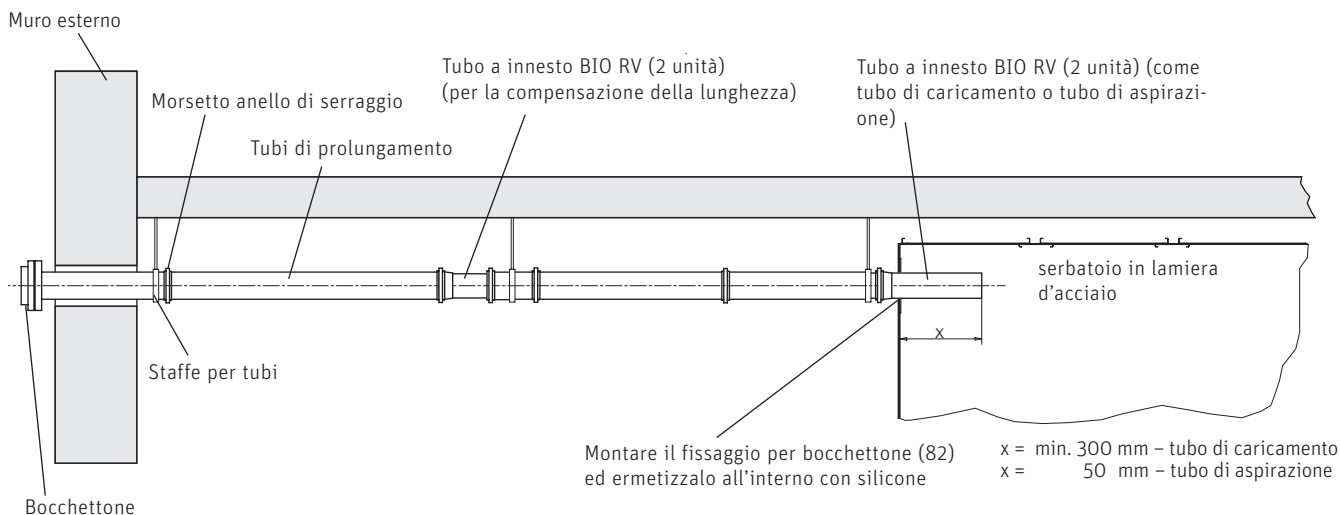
Bocchettone con tubo di prolungamento e serbatoio in lamiera d'acciaio – vista laterale
